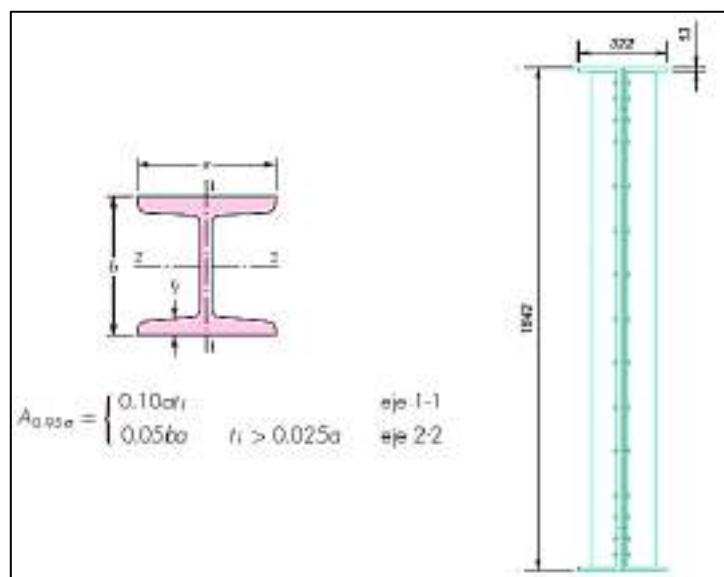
12 Vista de sección transversal de sección – Perfil I.
